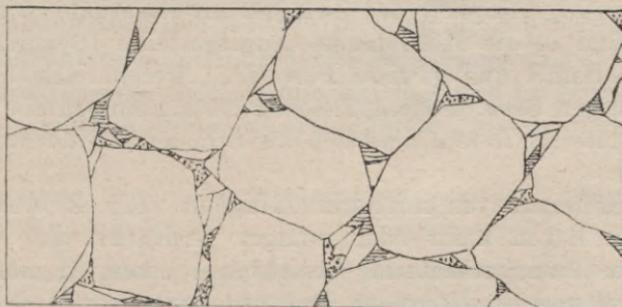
Guter Kleinschlag nach dem Einwalzen.
